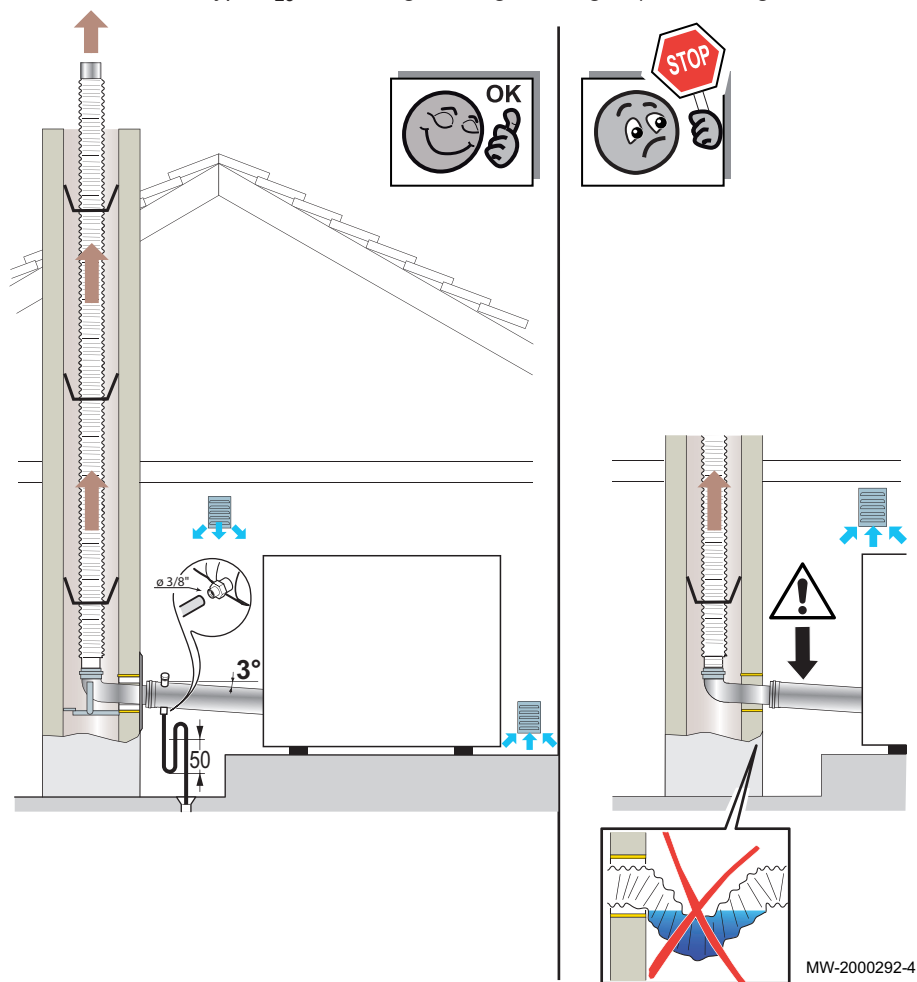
Starre type B₂₃ aansluiting - Rookgasleidingen (verbrandingsluchttoevoer uit de stookruimte)
